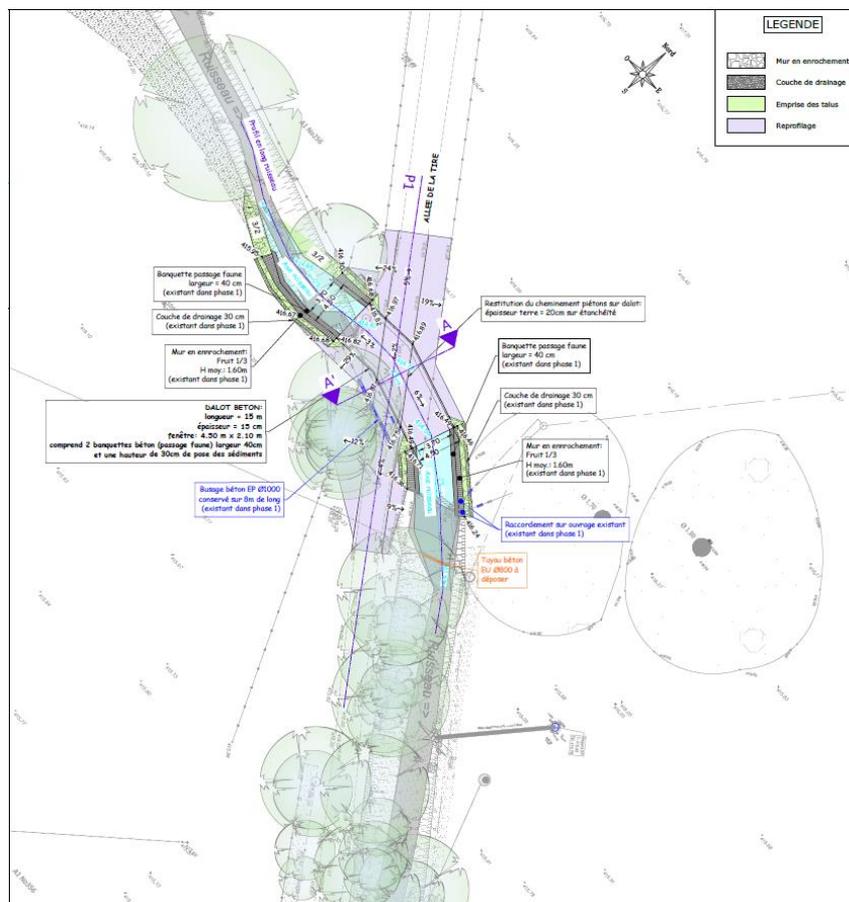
Étape 2 : Installation de l'ouvrage cadre définitif de franchissement du Nant, plan masse, PRO MS11 TLG, ABEST, Octobre 2024
